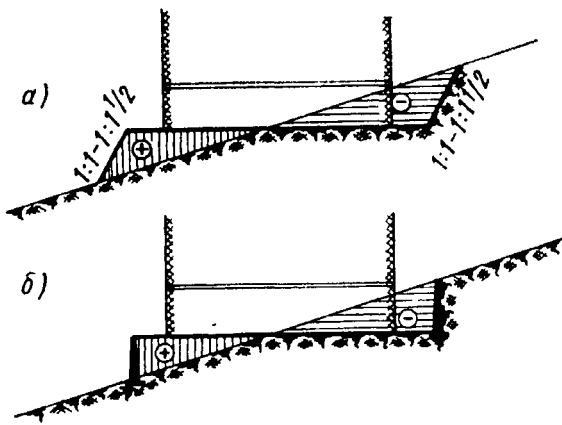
Вертикальная планировка площадки в полувыемке-полунасыпи
